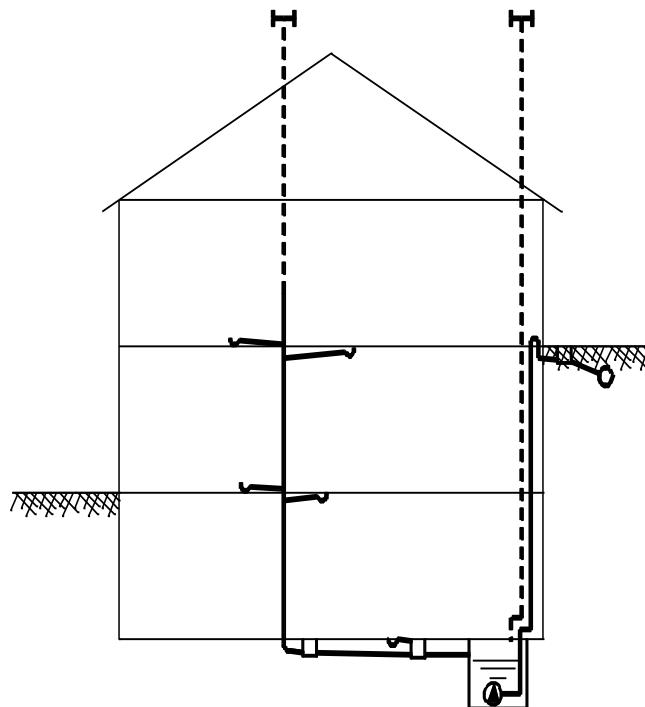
Sistema de drenagem predial sem ventilação secundária e com elevação
